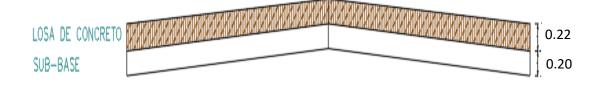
Estructura de Pavimento Vereda Gonzales. Fuente: Citec Ltda.
